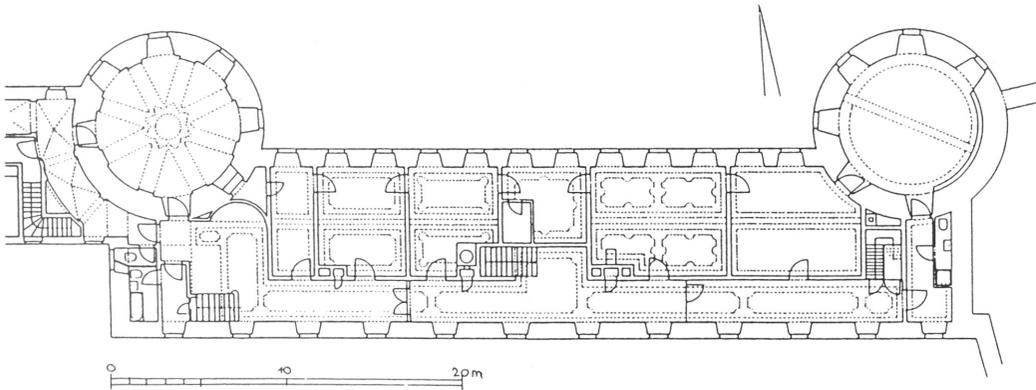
Schloß Aschhausen, Grundriß erstes Obergeschoß (Zeichnung: Verf.).
